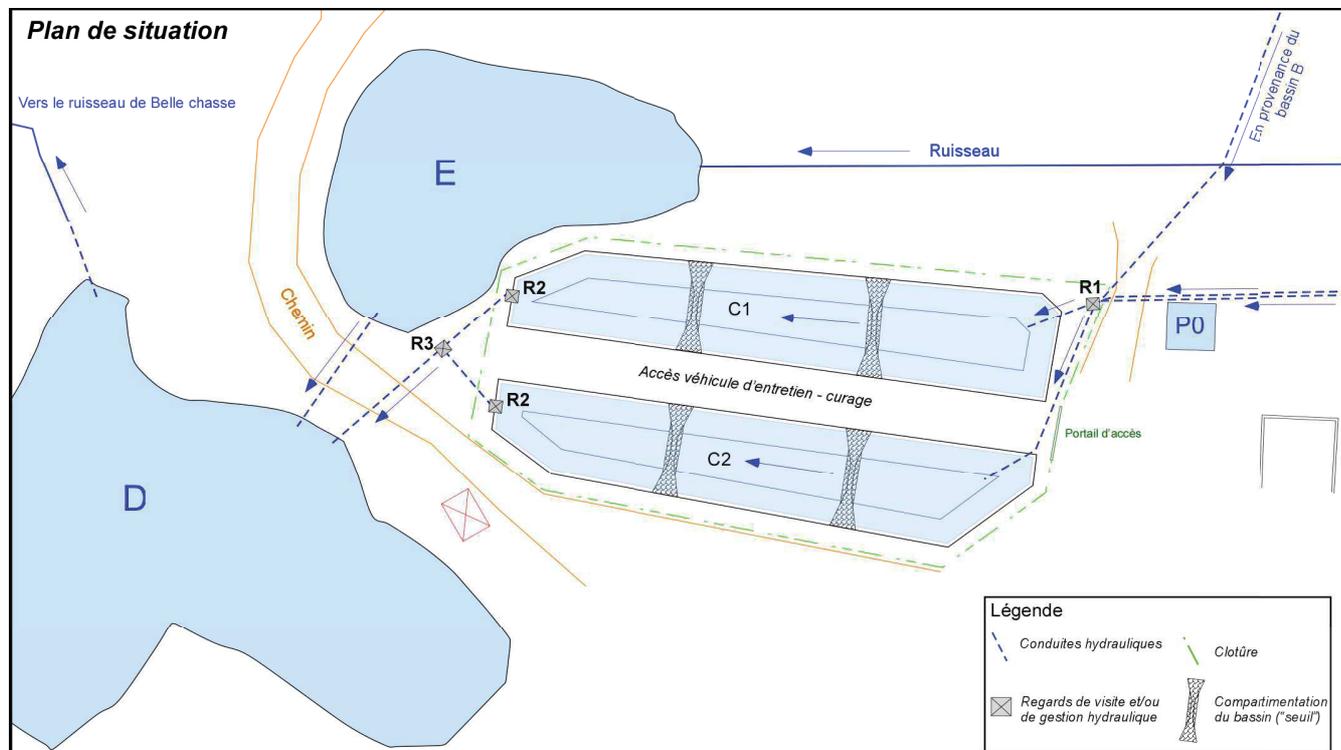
Plan d'aménagement (plan de situation) des bassins de décantation de la carrière Lariot.
